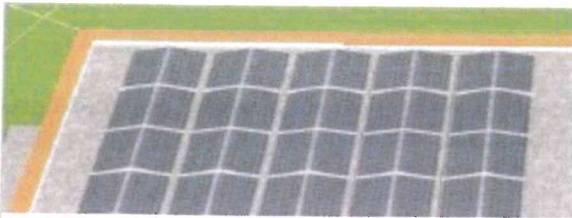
Detailplanung PV-Anlage – Ansicht (06-08-2020)
